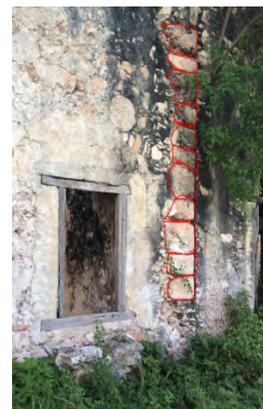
Detalle en muro. Piezas de piedra caliza. Fuente: Imagen propia de la autora.
